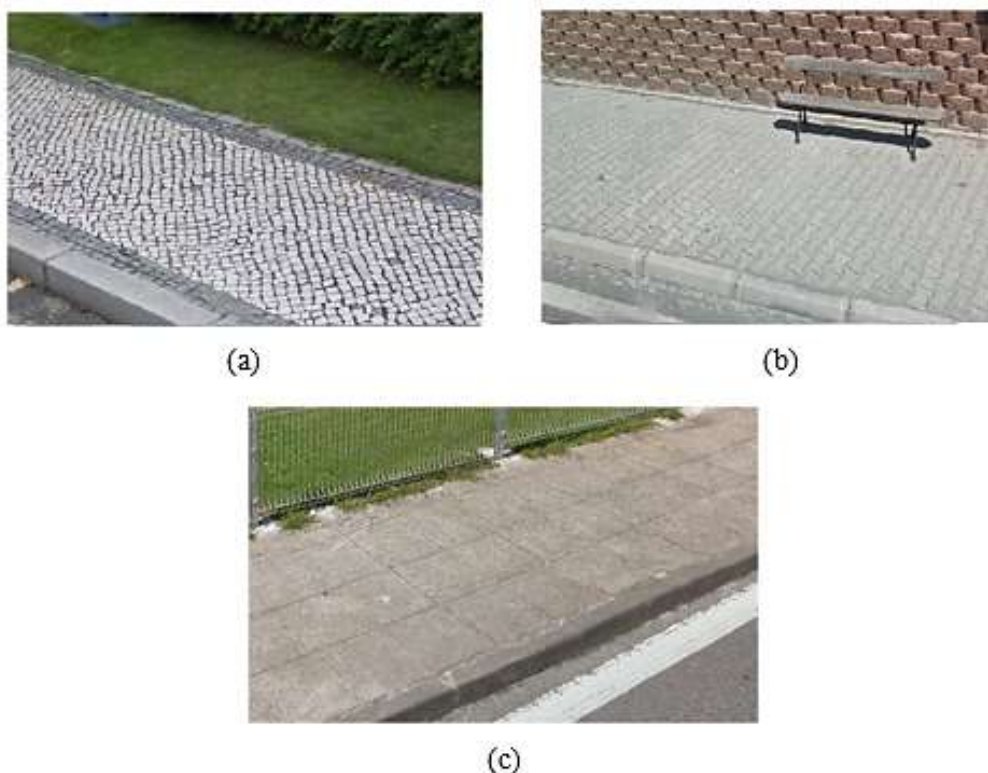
Materiais de revestimento de passeios (Covilhã): (a) Calçada Portuguesa; (b): Blocos de encaixe; (c) Betão ou argamassa de cimento
